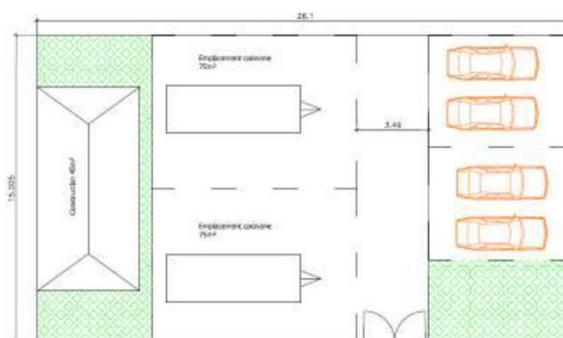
Plan type de l'aménagement d'un terrain familial / CABA
